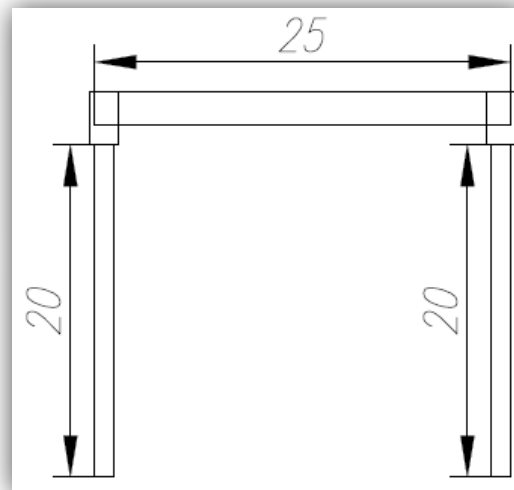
Esquema básico del puente con estribo integral. Esquema tipo pórtico
